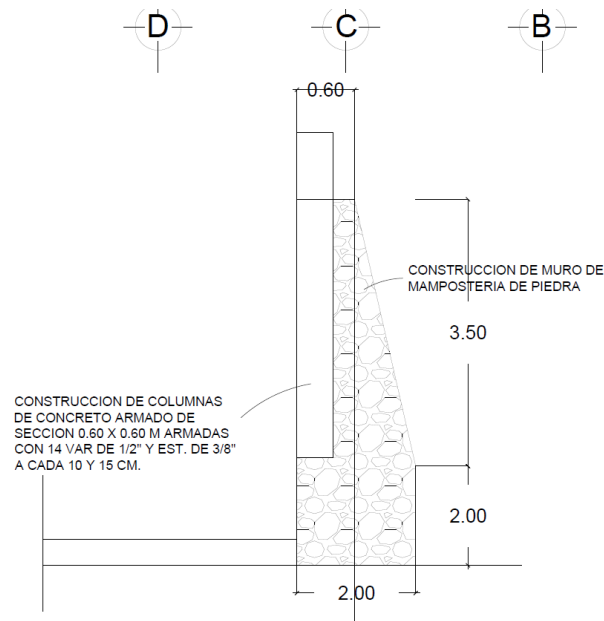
Ilustración No. II.9 Sección transversal del muro de contención del proyecto.
